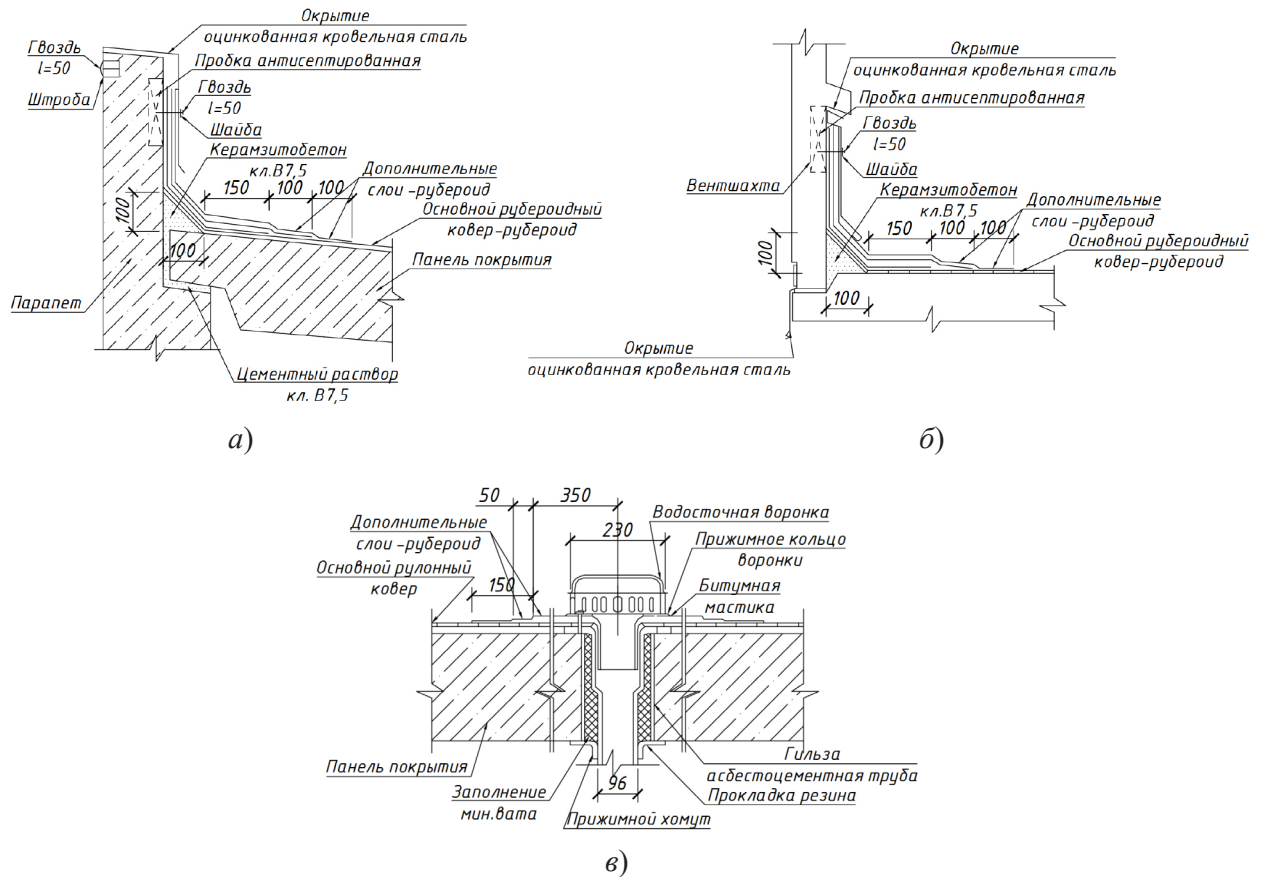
Узлы кровли: а – примыкание кровли к парапету; б – примыкание кровли к венткамере; в – установка воронки внутреннего водостока
